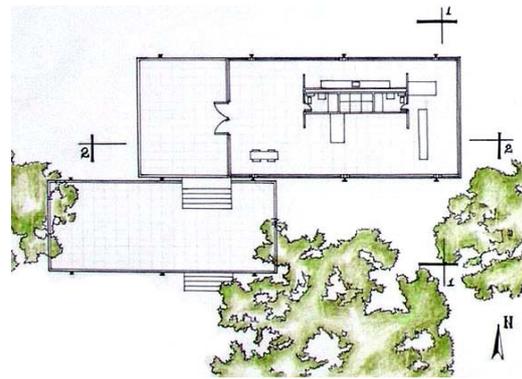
Planta casa Farnsworth, exemplo casa extrovertida.
